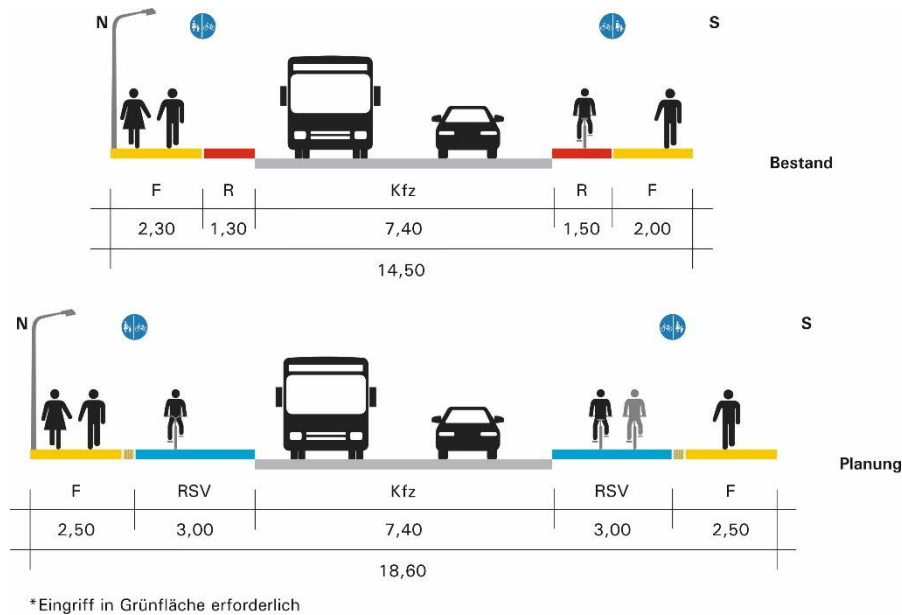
Querschnitt Abschnitt Lübecker Straße (A-20; Bestand und Planung)
